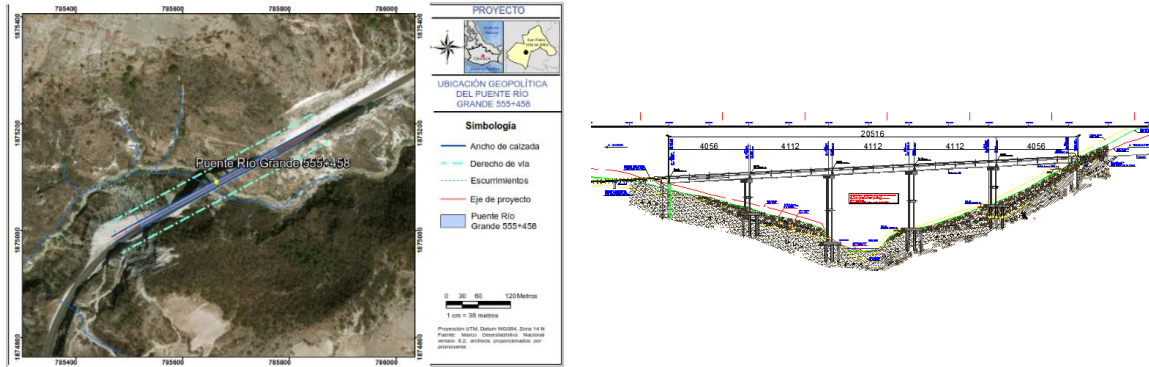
Proyecto en planta y perfil longitudinal del Puente Río Grande 555+458.
